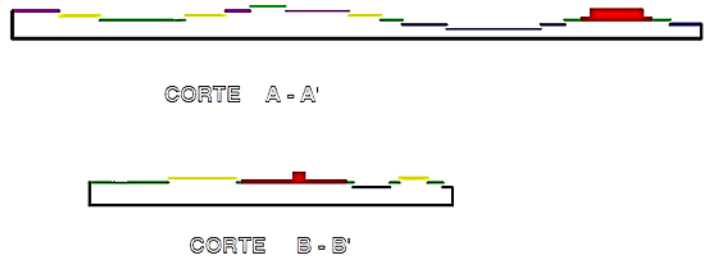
Cortés Juan. Cortes A -A' de Sur a Norte y B - B' de Oriente a Poniente, mostrando los niveles del terreno y la posición en rojo del Edificio Uno. 2015. Planos arquitectónicos C-01. Acervo J. Cortés.
